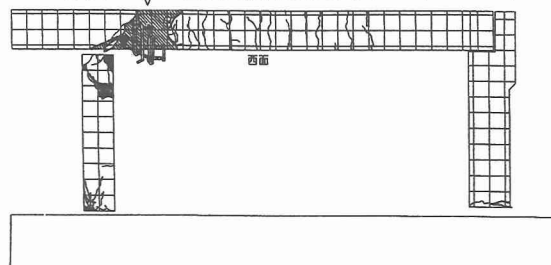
ひび割れ状況 (I-10, H=3.5m)
